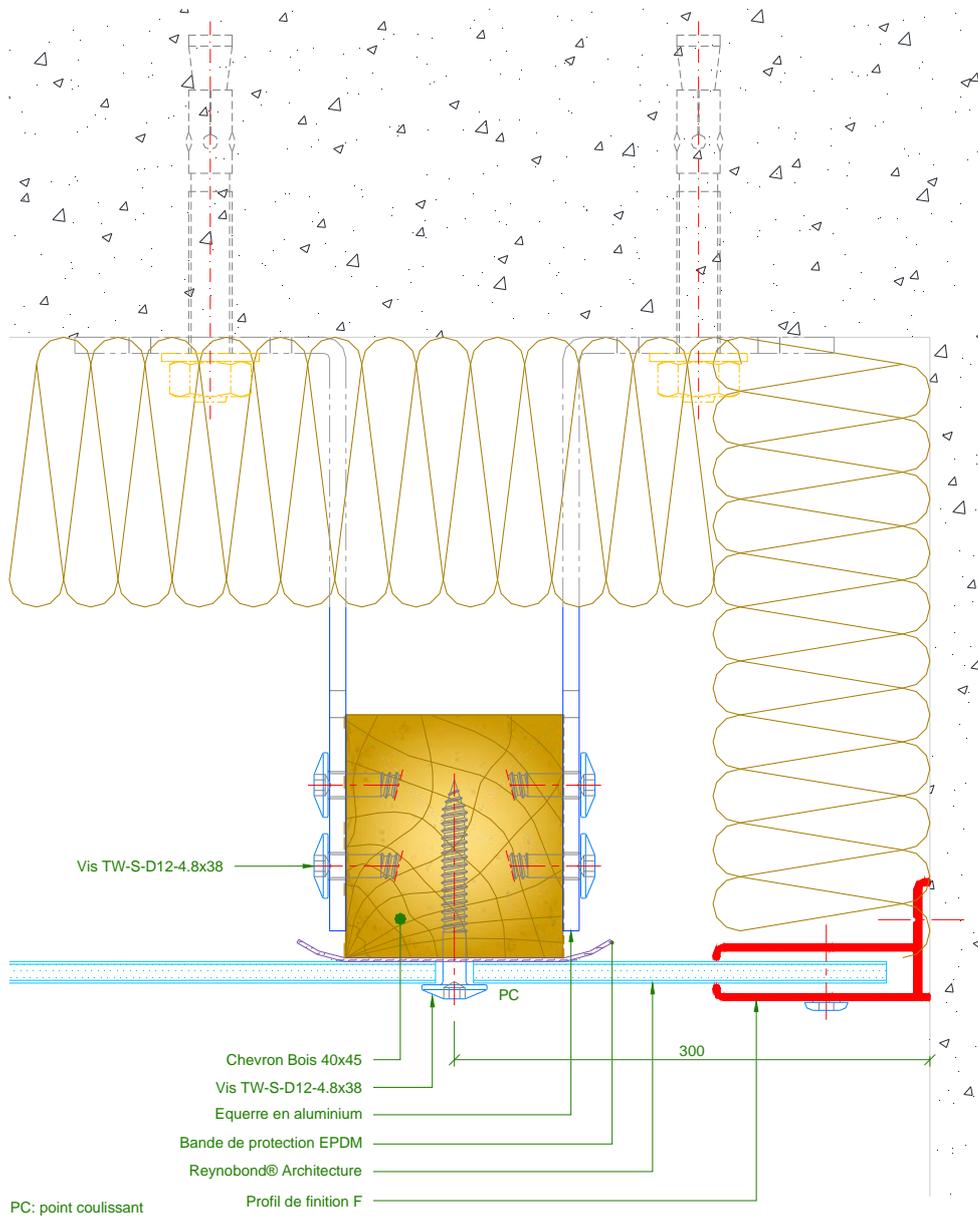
Arête sur acrotère – Système vissé SW 2c (Coupe verticale)
